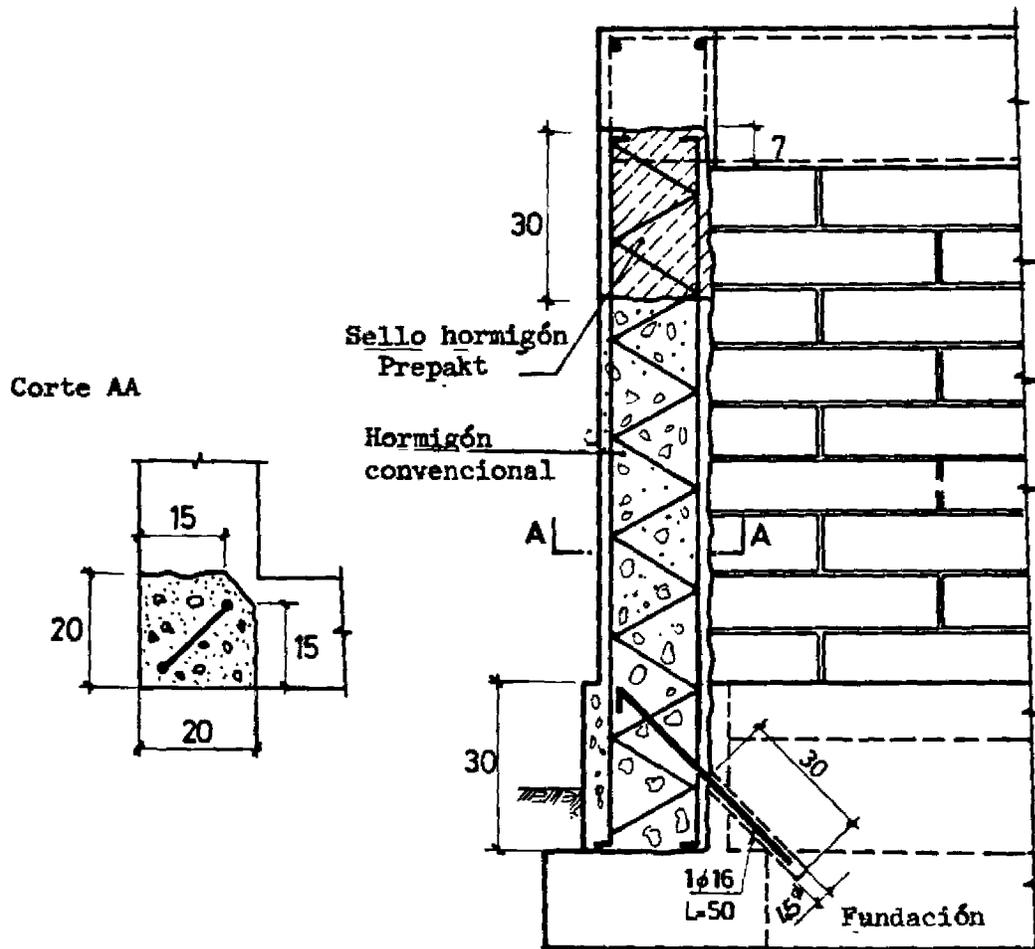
Caso R-2. REFUERZO DE VIVIENDA EN ALBAÑILERÍA DE LADRILLO DE ARCILLA CON TENSORES; QUE SON REEMPLAZADOS POR HORMIGÓN ARMADO
